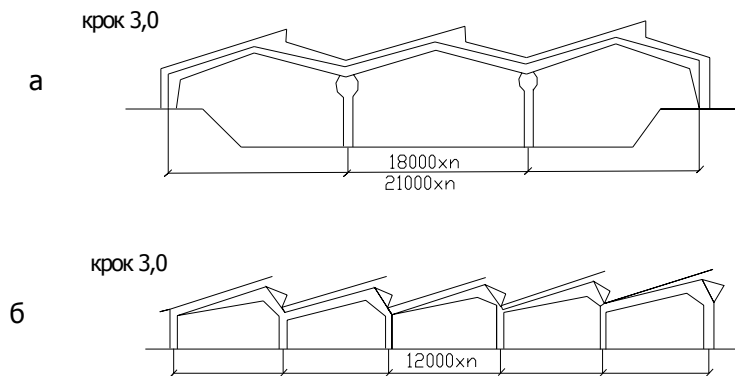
Конструктивні схеми багатопрольотних будинків
